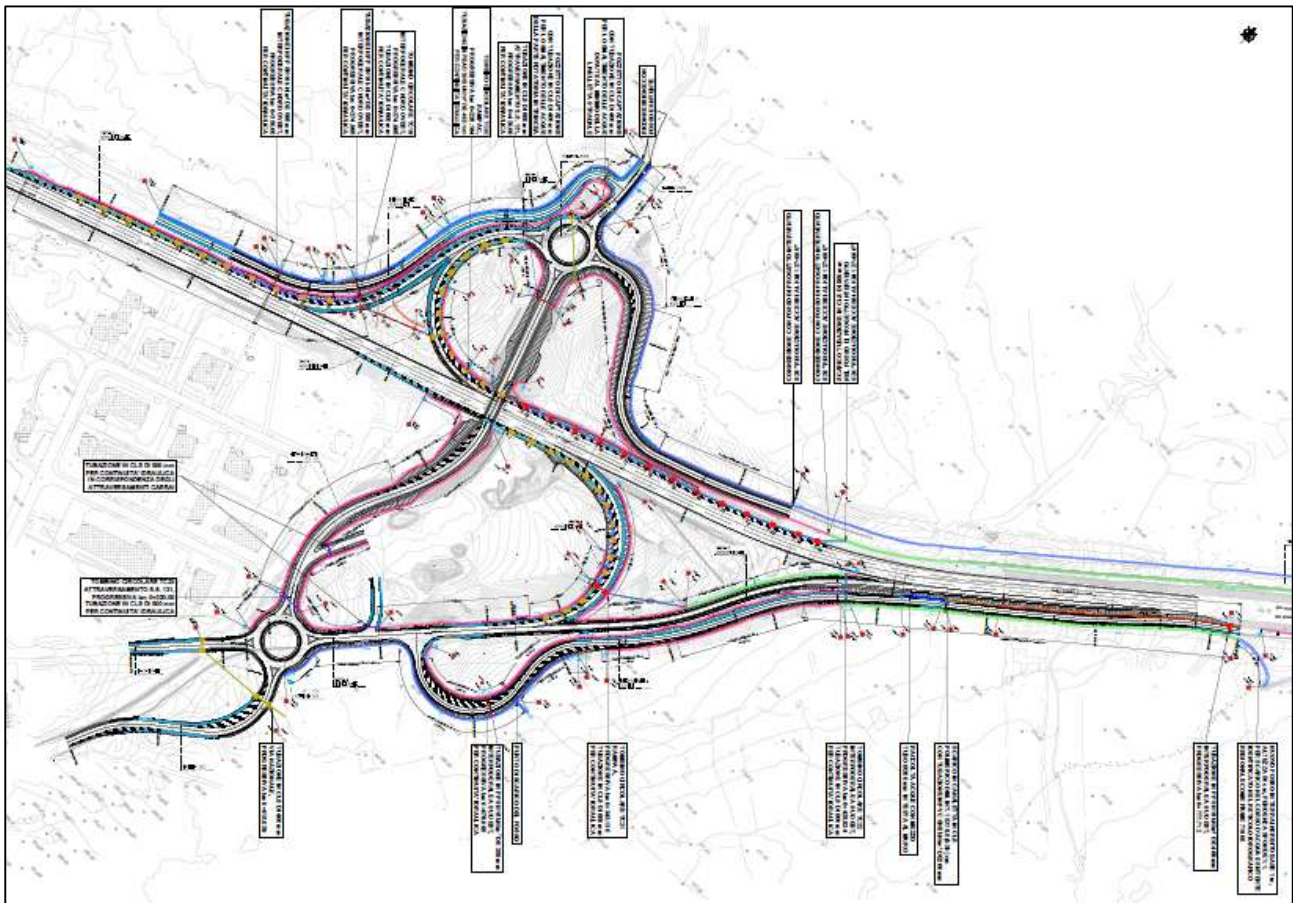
Stralcio planimetrico intervento V01-Nuovo svincolo di Paullatino al km 120+000
